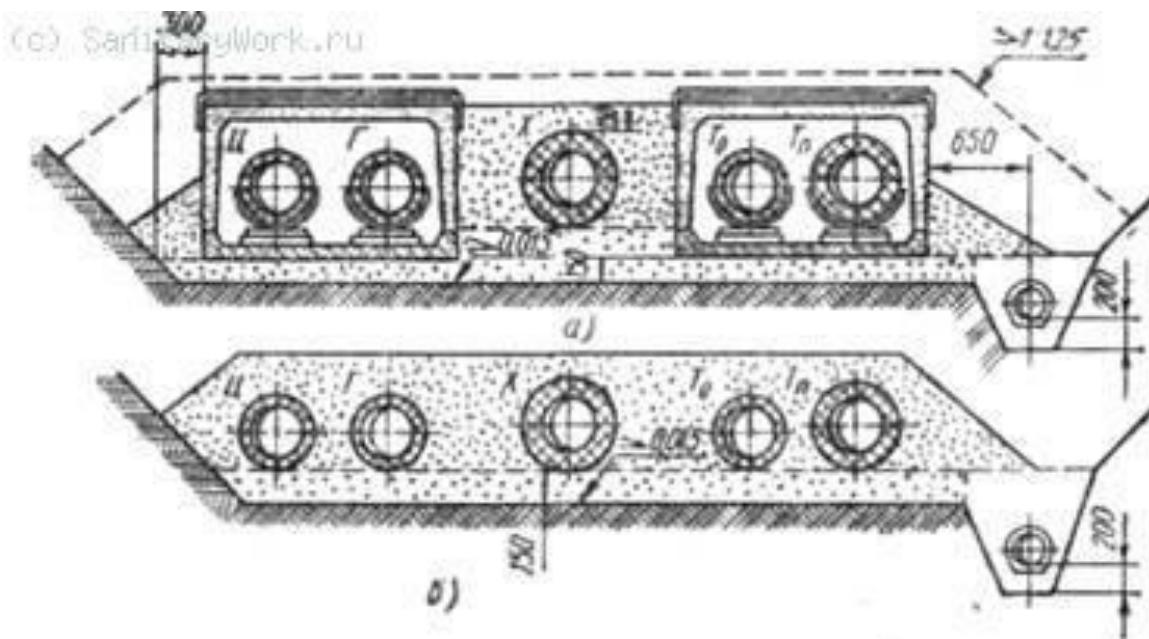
Прокладка тепловых сетей: а — в непроходном канале с битумоперлитовой изоляцией, б — бесканальная, Ц — циркуляционный трубопровод, Г — трубопровод горячей воды, Х — трубопровод холодной воды, Т — обратный трубопровод системы отопления, Гп — ведущий трубопровод системы отопления
